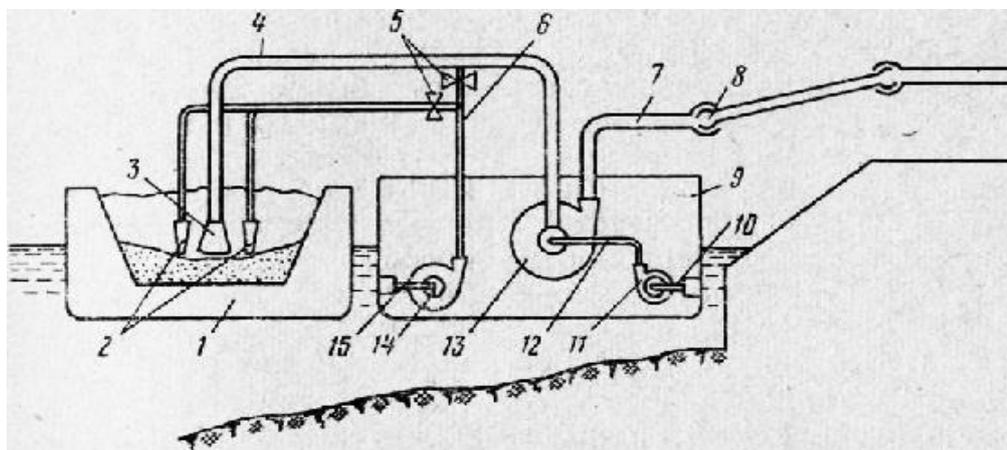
Схема гидроперегрузателя всасывающего типа:
